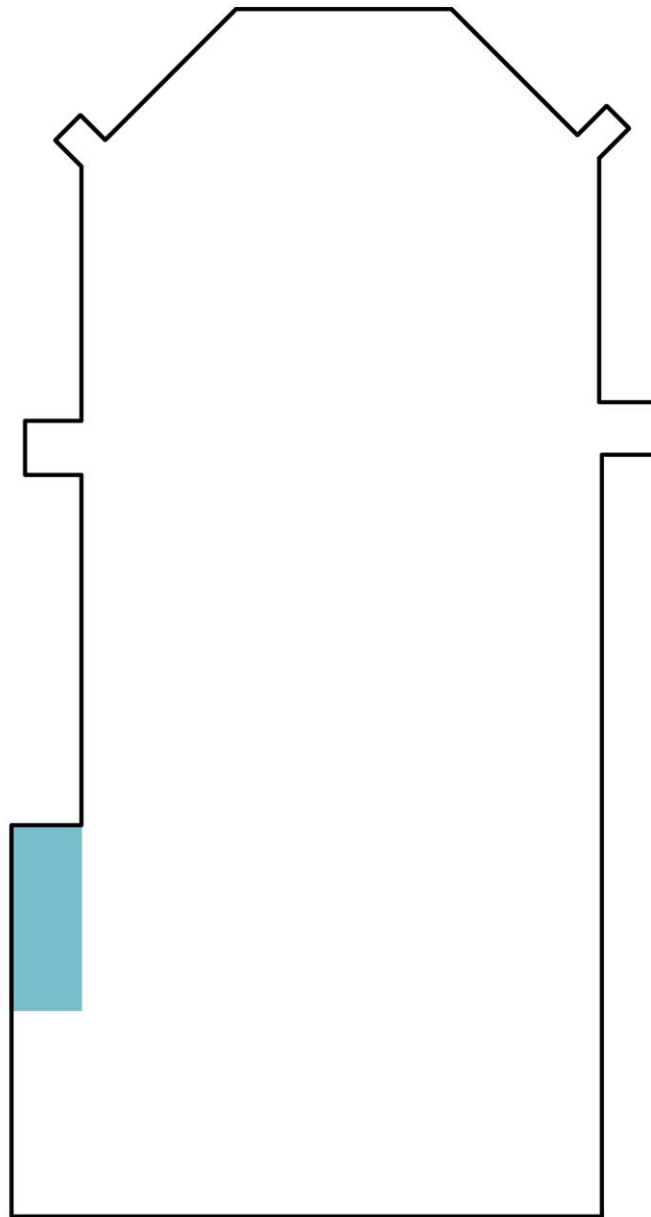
Plano de la planta iglesia de Sta. Marta.
